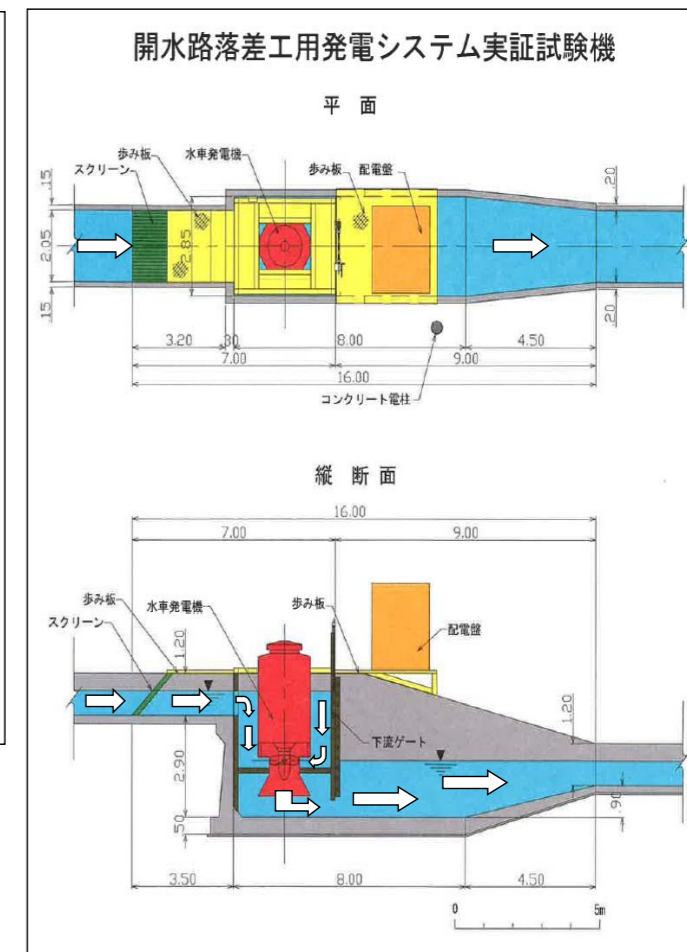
開水路落差工用発電システム実証試験機 平面図・縦断面
